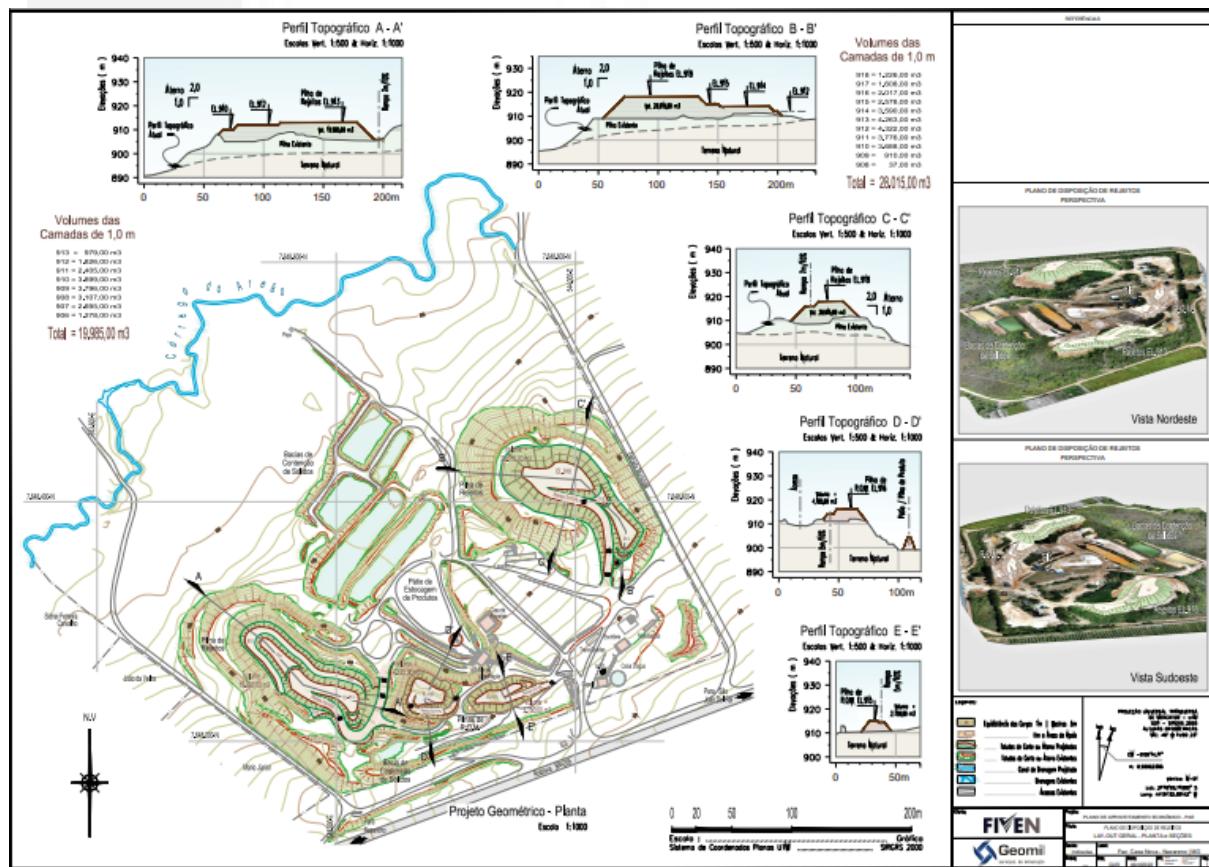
Planta da configuração das pilhas de rejeito após alteamento.
